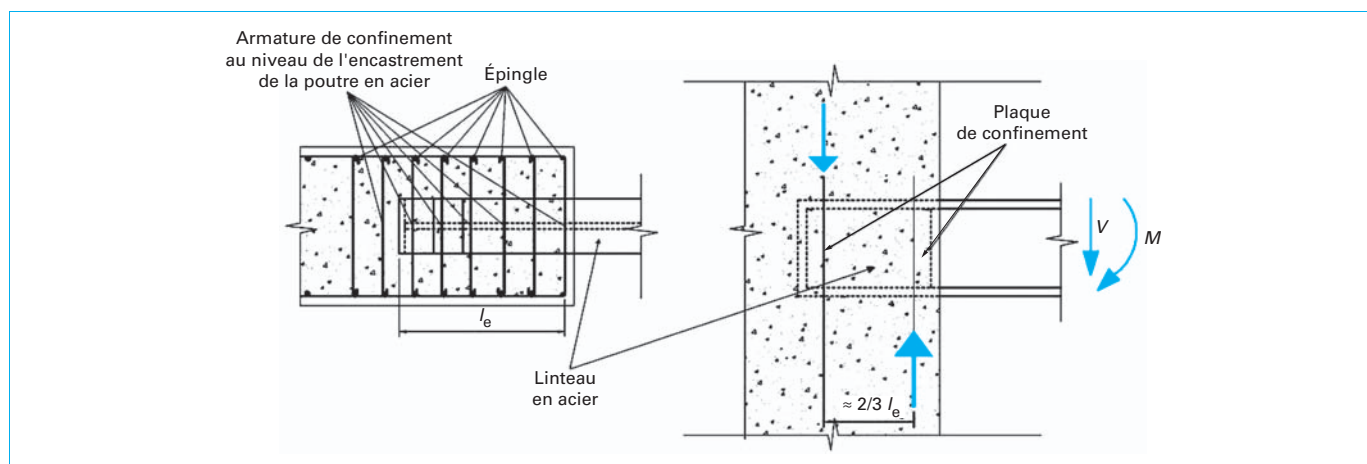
Détails d'un linteau fixé dans un mur (armatures transversales de classe de ductilité DCH)
